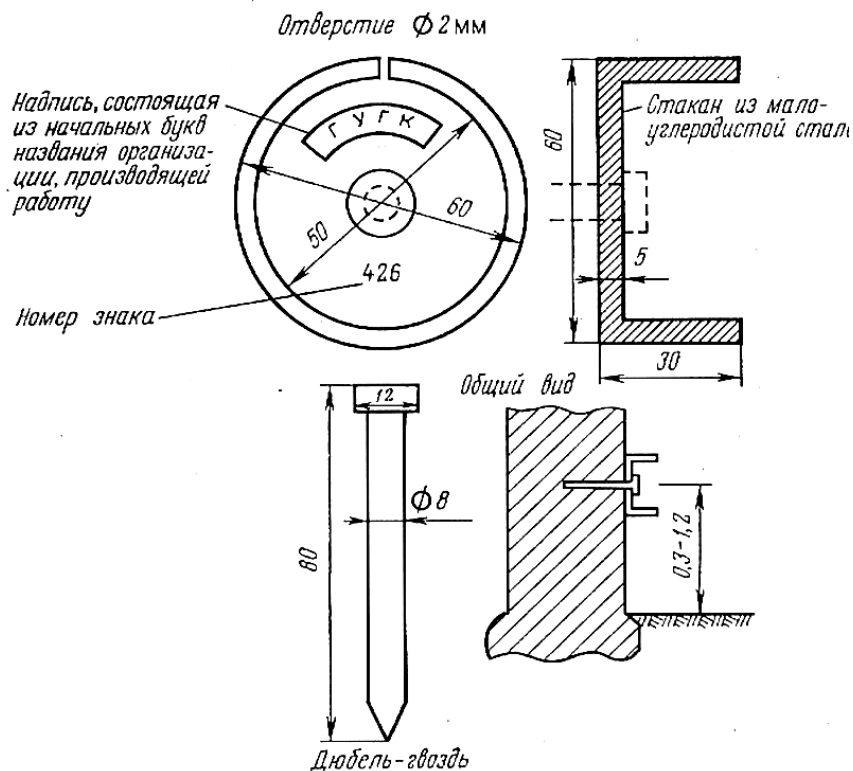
Конструкция стенного знака – репер типа 7 г.р.
